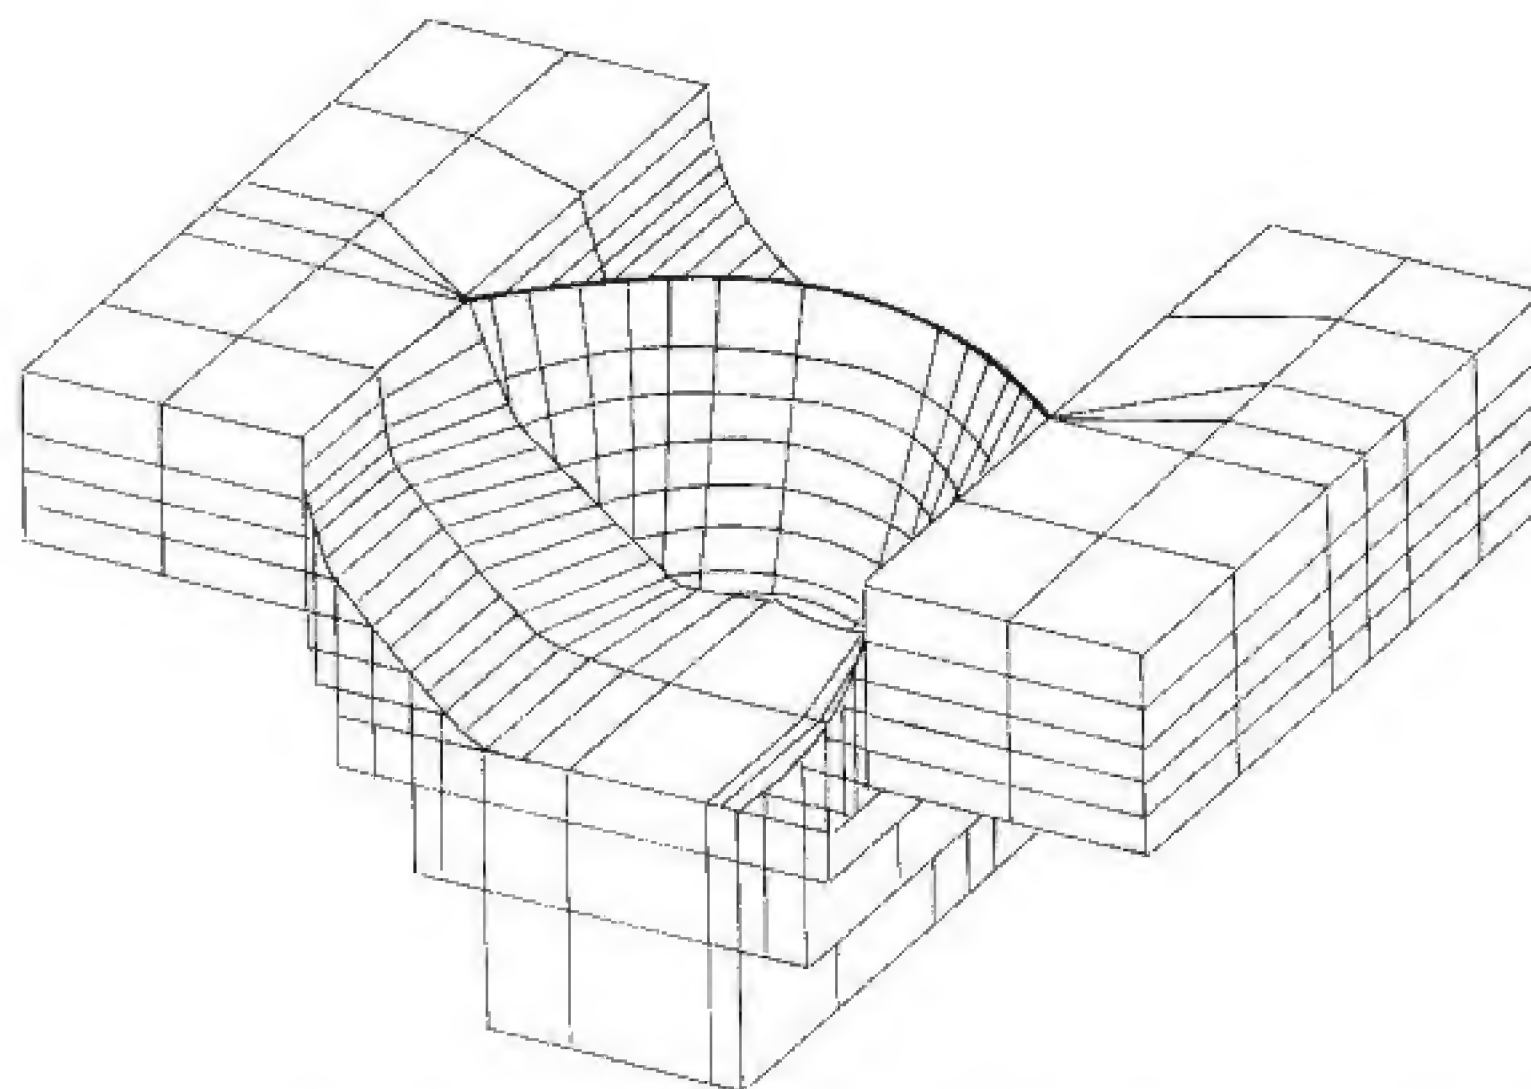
Exemple d'une modélisation d'un barrage-voûte et de sa fondation par éléments finis (selon Jansen, 1988).
